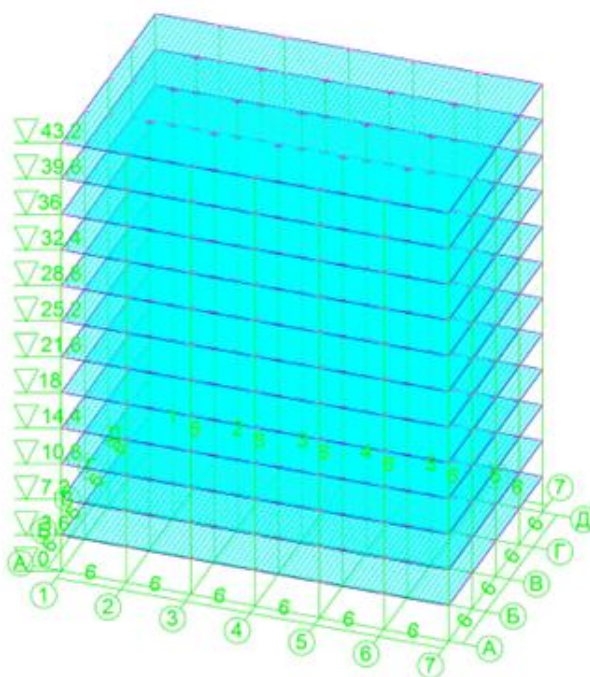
Схема многоэтажного каркаса с безригельными перекрытиями
